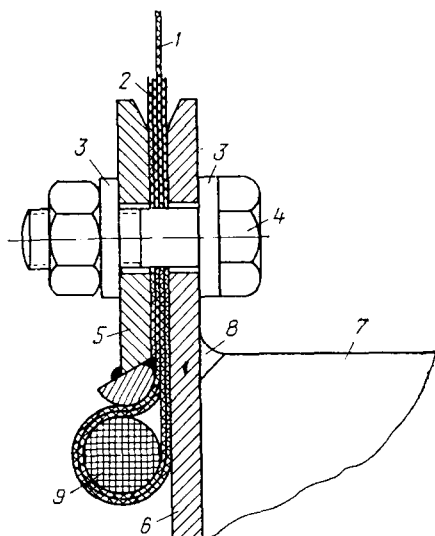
Вариант крепления оболочки к ленточному бетонному фундаменту
